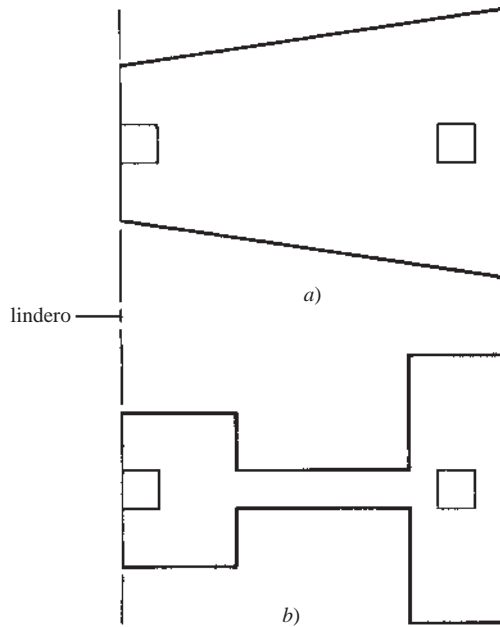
Zapatas trapezoidales y zapatas de tira o en forma de T.
